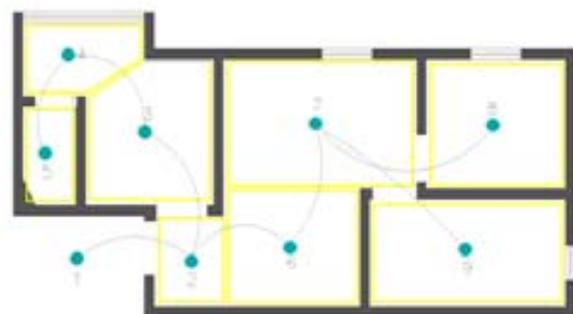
QELC 01, Bloco B1 - Planta Modificada
